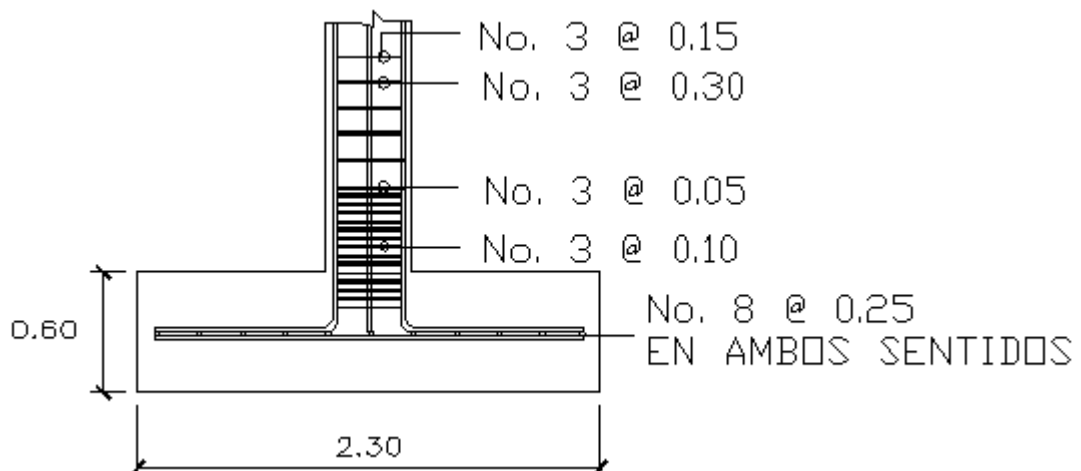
Sección A-A' del armado propuesto de zapata A-1
